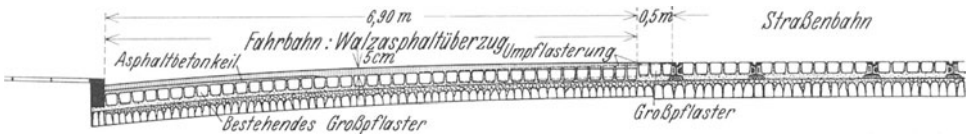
Walzasphaltüberzug auf einer Steinpflasterstraße in Stuttgart.
